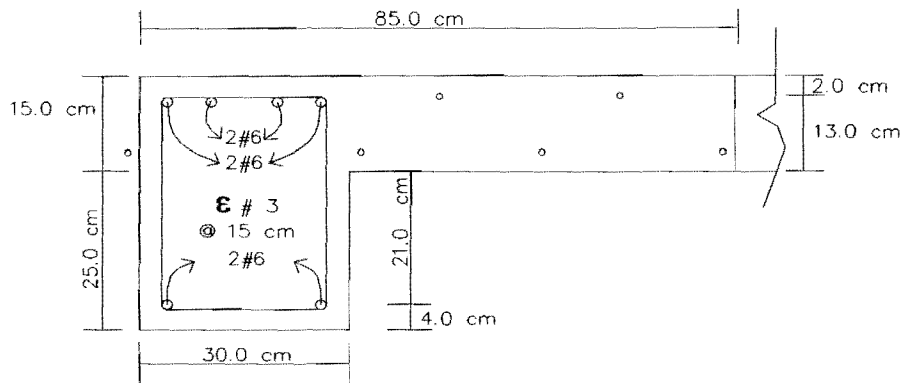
Dimensiones y refuerzo para las vigas del marco externo
